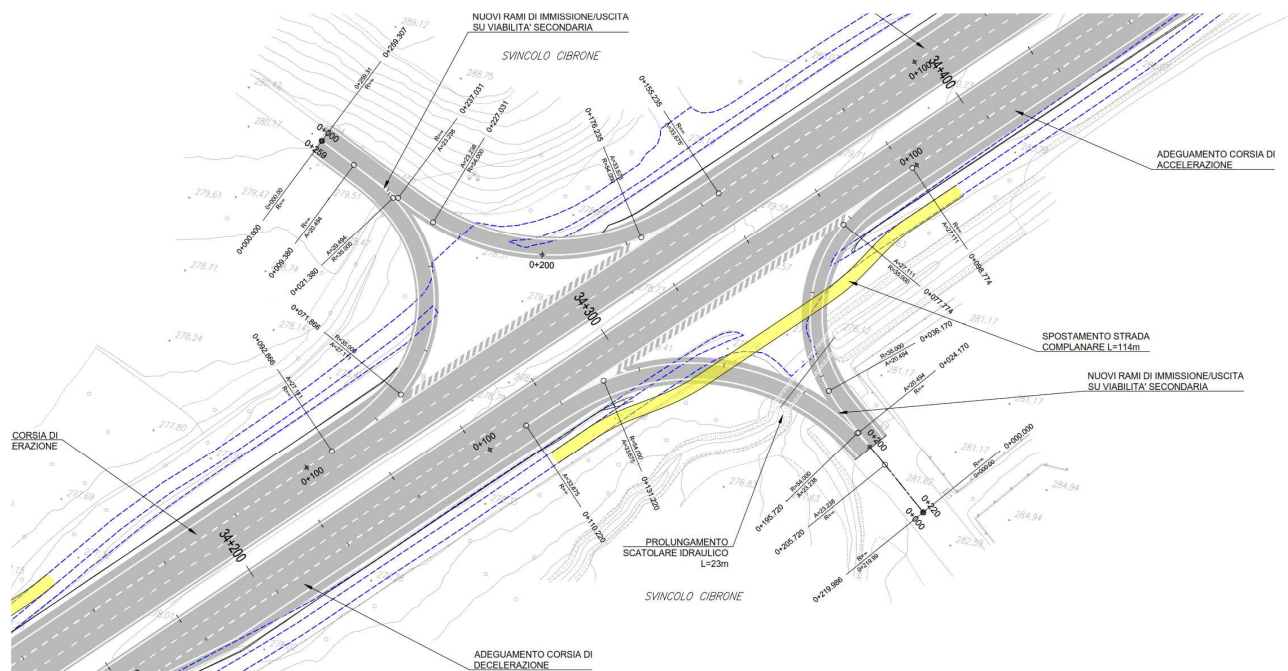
Stralcio planimetrico soluzione progettuale dello svincolo di Cibrone
